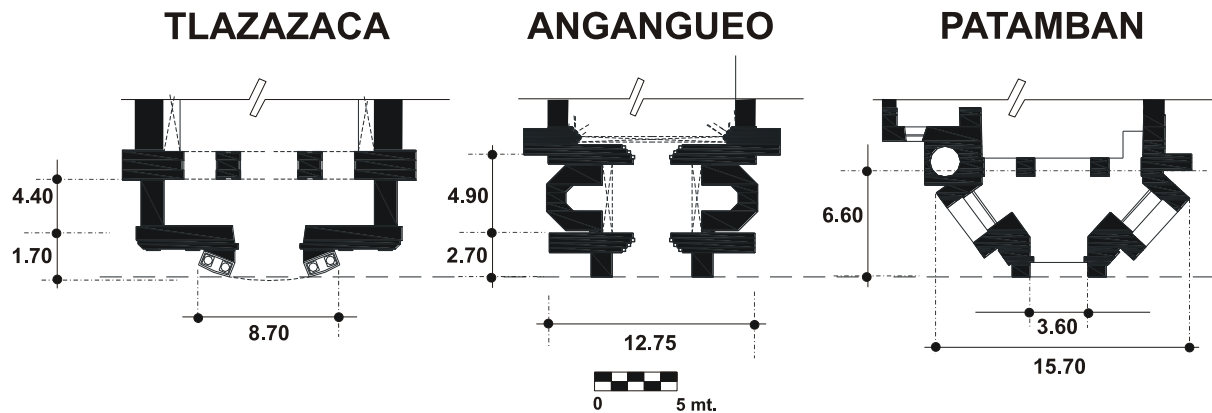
VARIANTE DE PLANTA TIPO 2
